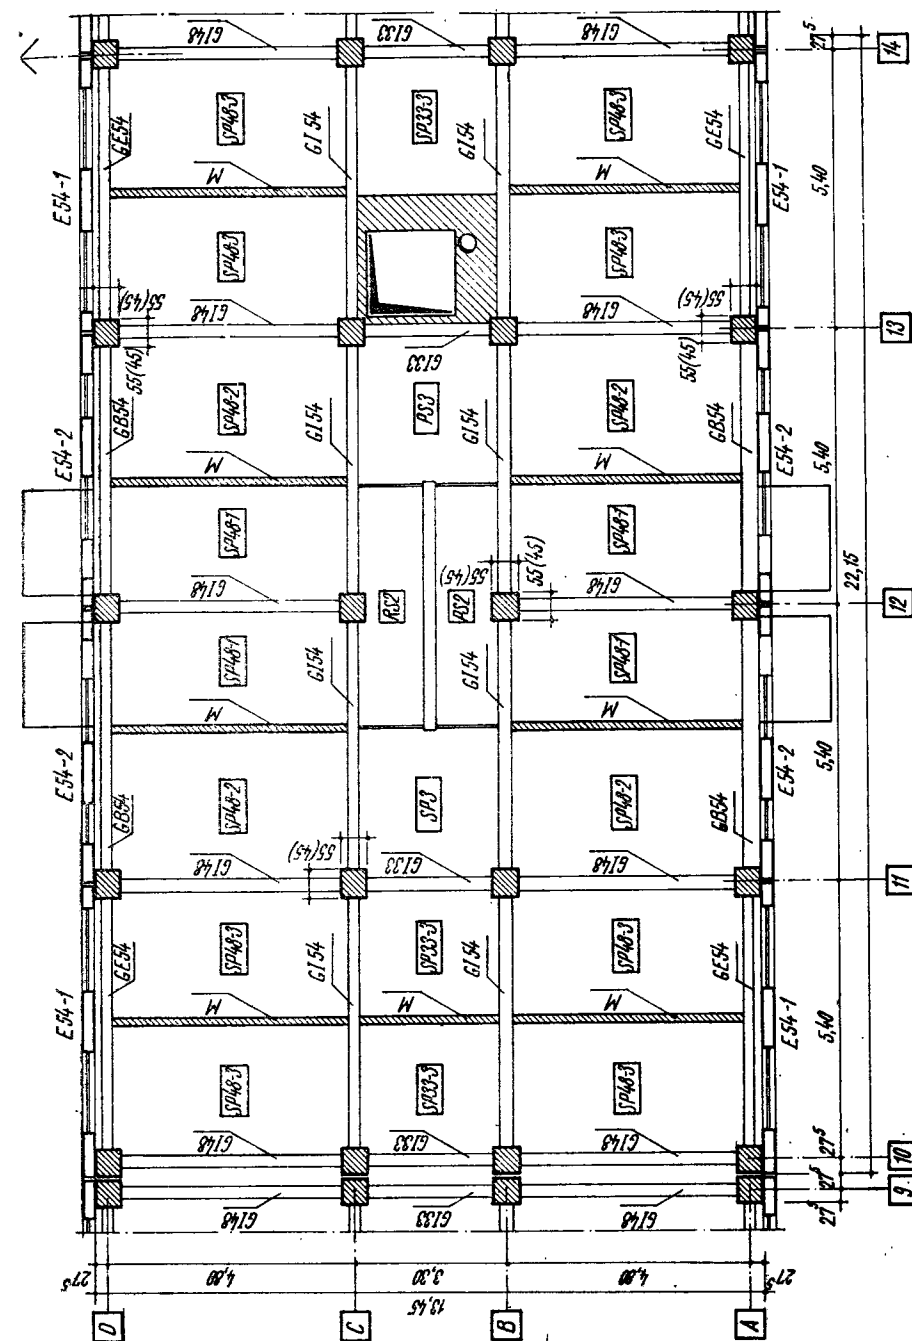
Plan poză prefabricate pentru o structură, P + 10E, din cadre de beton armat turnate monolit cu planșee din semipanouri prefabricate care reazemă pe grinzi prefabricate și cu panouri mari prefabricate pentru pereții exteriori:
